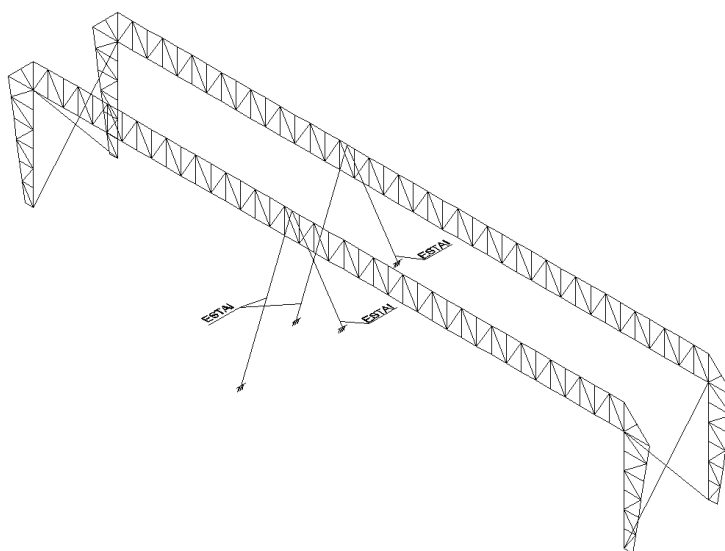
Montagem da viga de cobertura do pórtico seguinte
